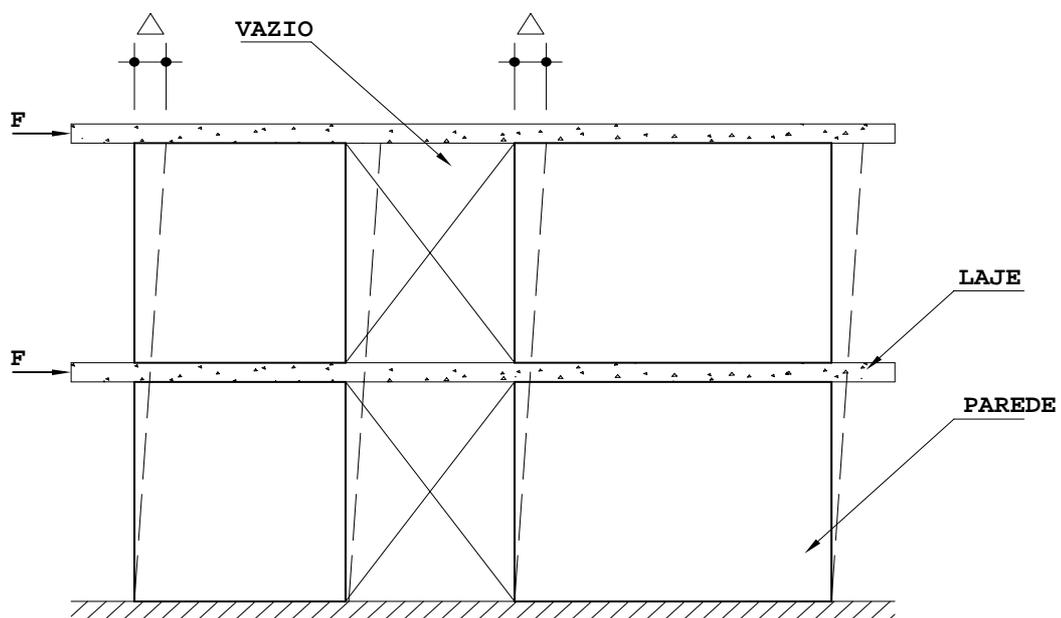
Deslocamento horizontal em paredes de contraventamento.
